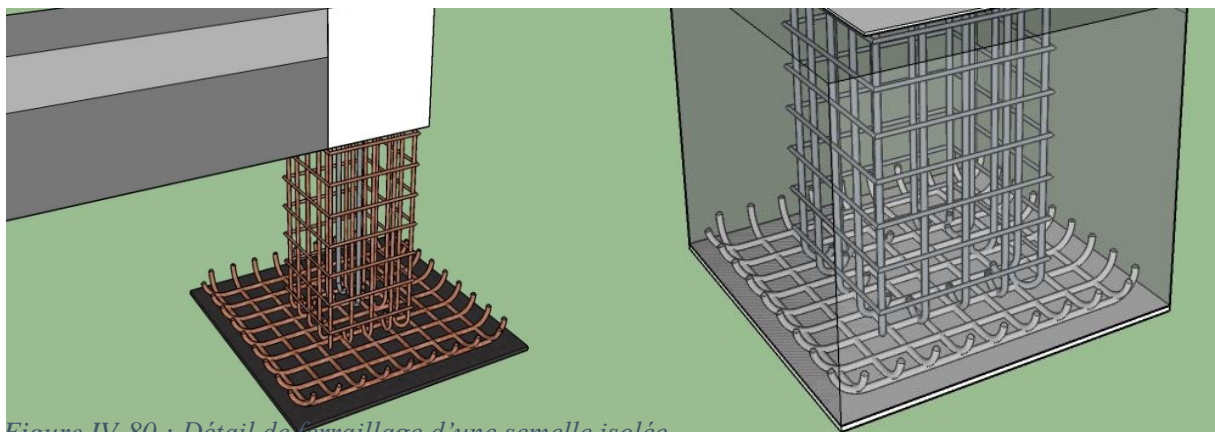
Détail de ferrailage d'une semelle isolée.
